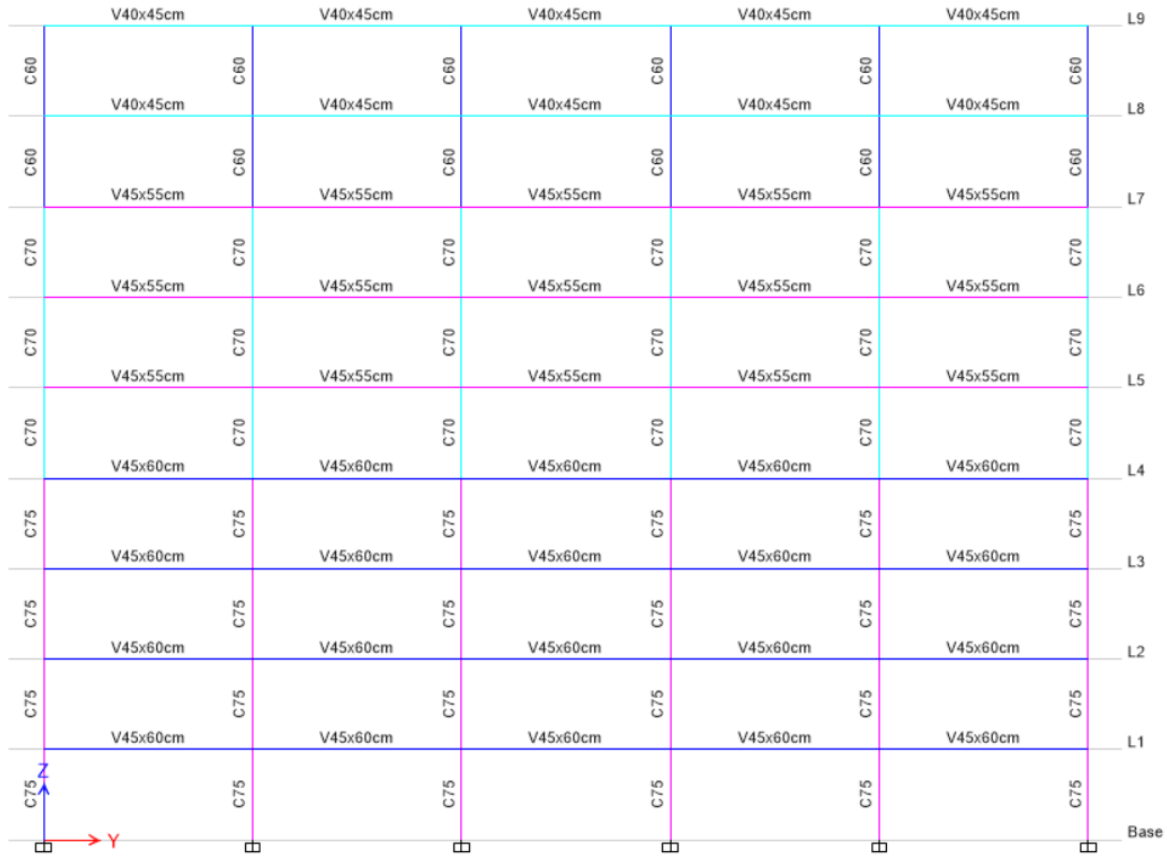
Configuración de un pórtico exterior de las secciones para un edificio de 9 pisos. Para un pórtico interior en una vista y-z, se tiene que en las losas L1 a L4 se utilizó la viga 1. Para las losas L5 a L7 se utilizó la viga 3 y para la dos últimas losa se utilizó la viga 5. Para las columnas intermedias se usó una columna de 80 cm, la cual llega hasta L4, de ahí cambia de sección a 70 cm hasta L7, terminando con una sección de 60 cm para las ultimas losas.
